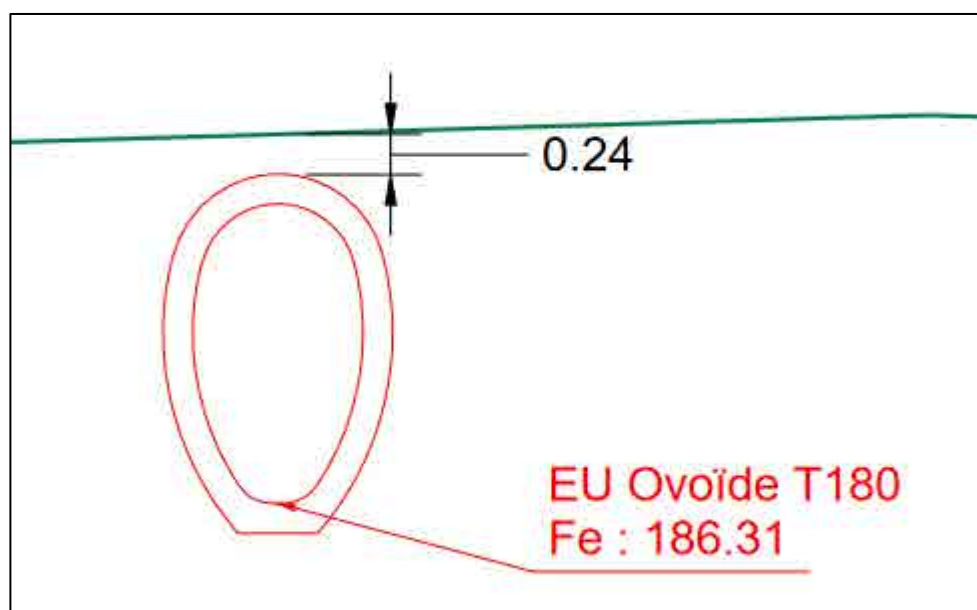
Coupe existante d'un ouvrage prof. 0,5 m
